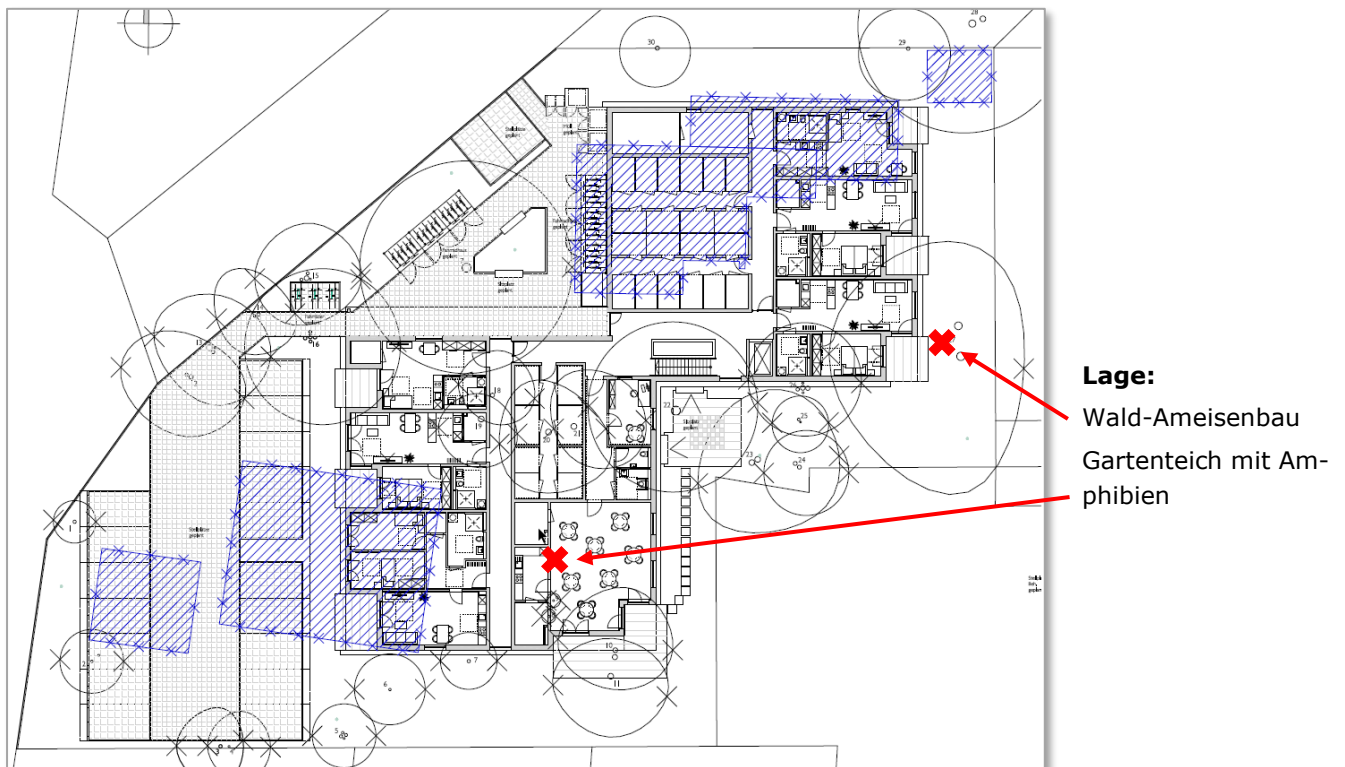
Übersicht der beiden Grundstücke mit Baumbestand und Bestandsgebäuden/Bauplanung (LA Wolf 5/2024)
